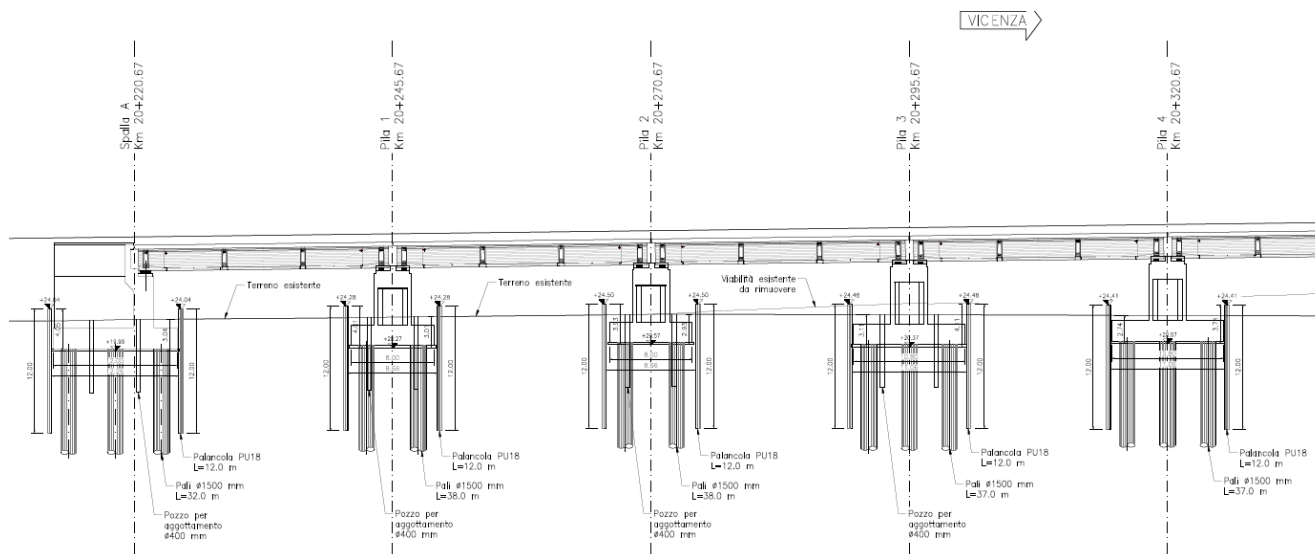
sezione longitudinale da spalla A a pila 4
